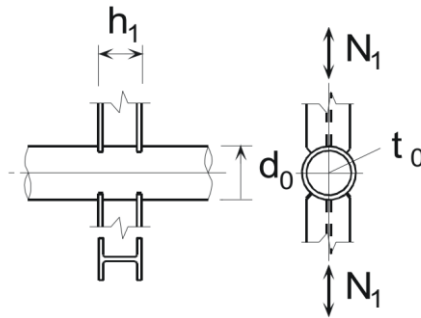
JUNTA SOLDADA EM X ENTRE DIAGONAIS DE PERFIL I OU H E CORDA CHS (EC3-1-8 , QUADRO 7.4)
